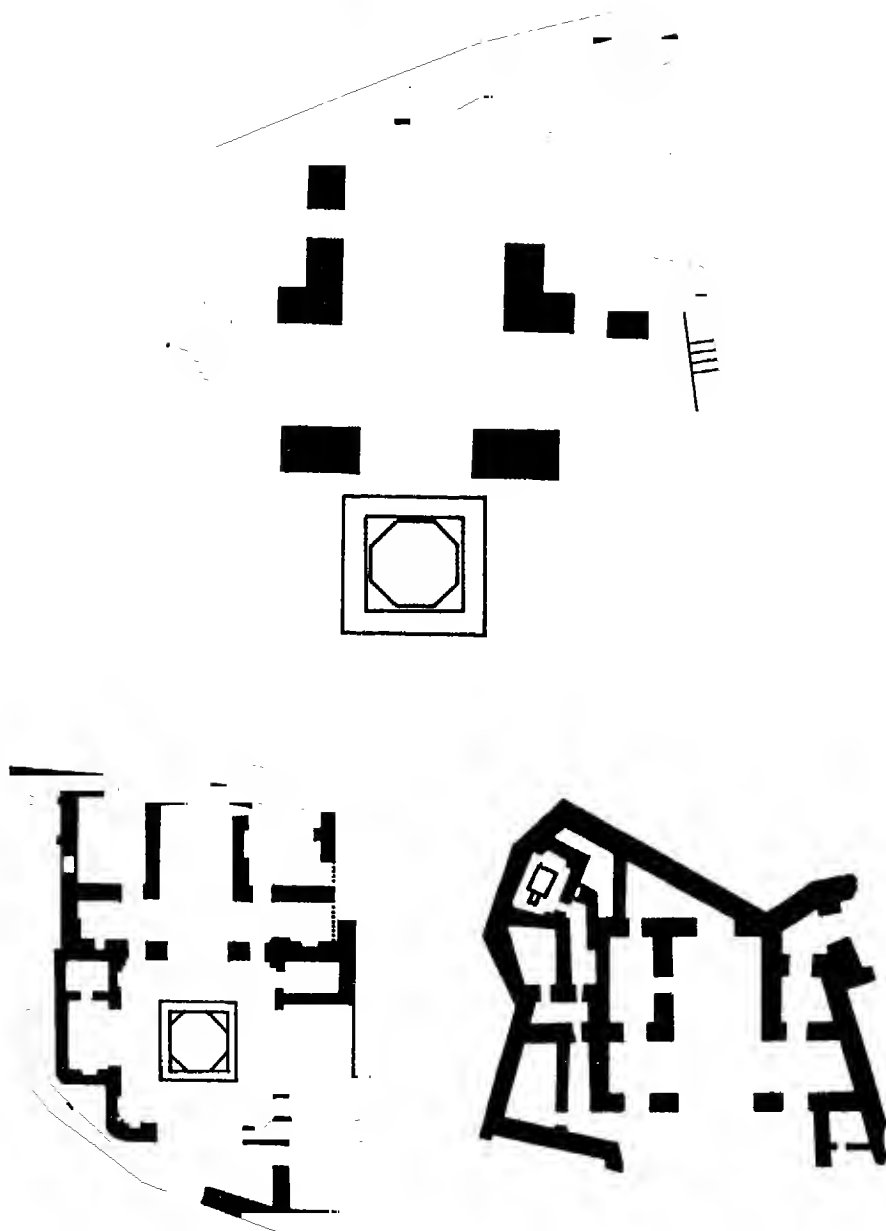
مسقط أفقي لجامع عمرو بن العاص بالفسطاط
